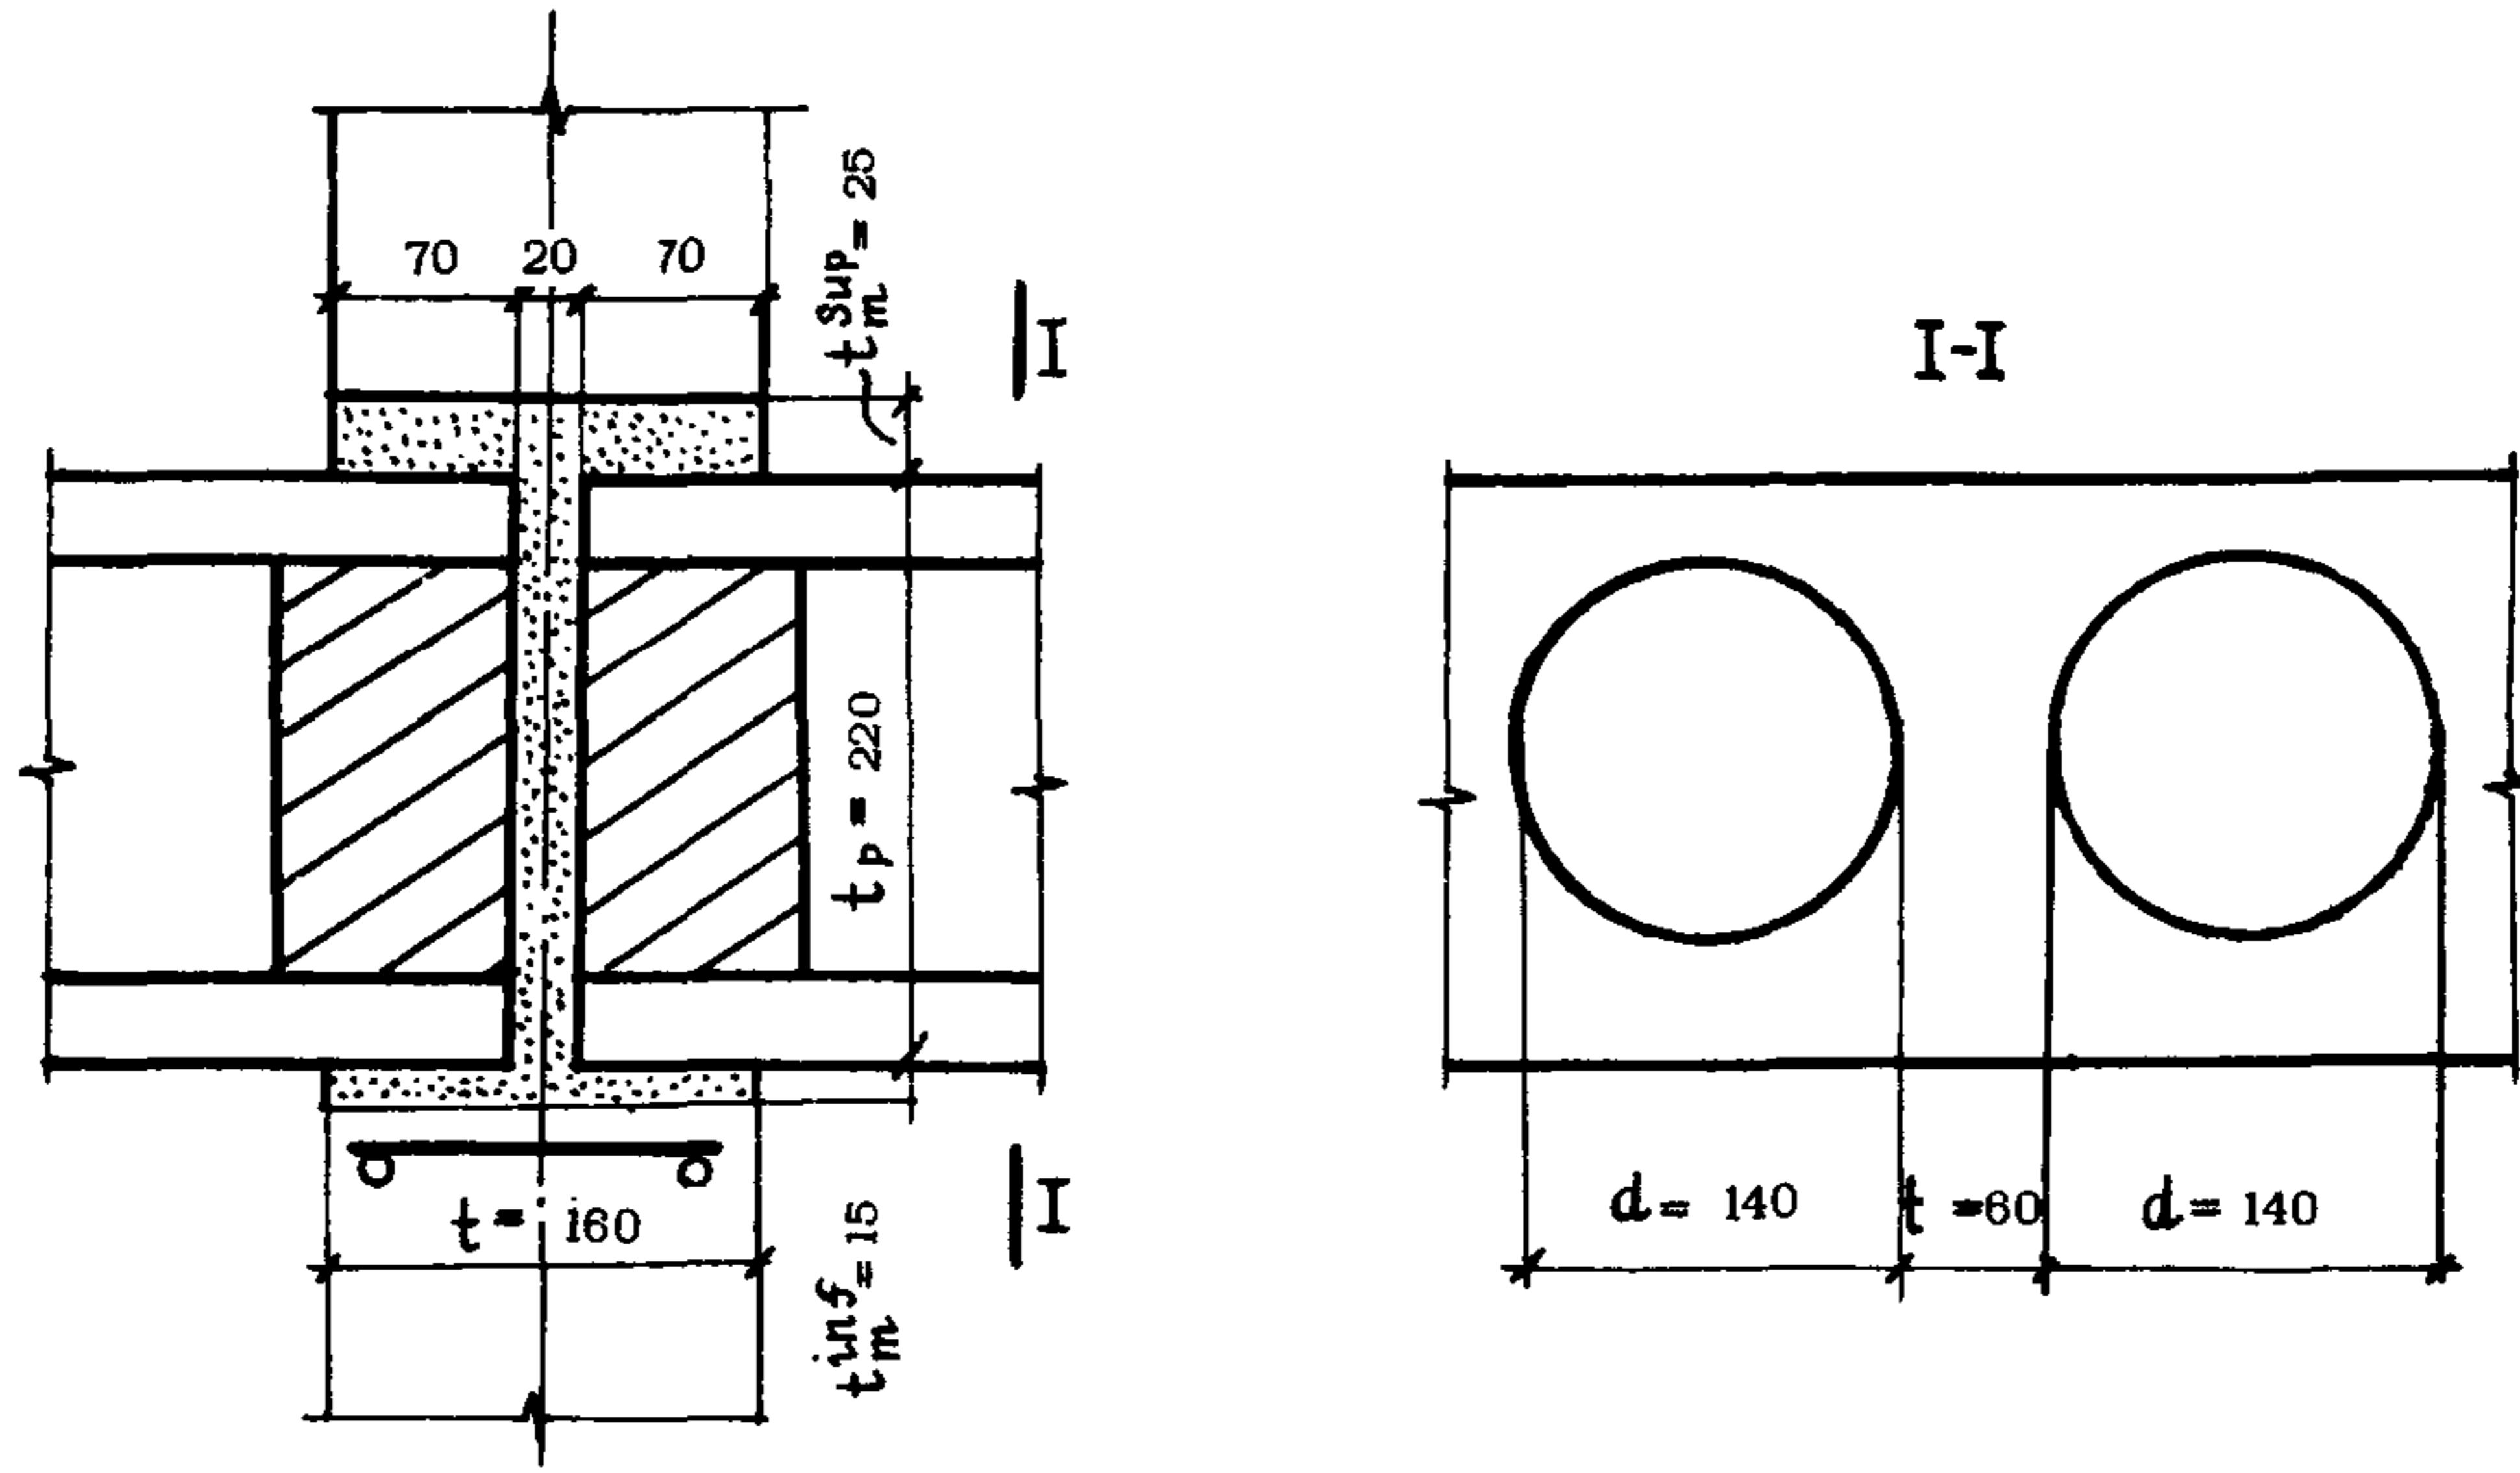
Платформенный стык внутренней панельной стены при двухстороннем опирании плит перекрытий (к примеру 1)
